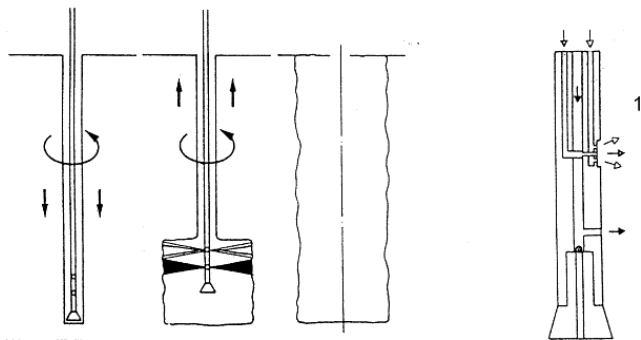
Jet Grouting - Injeção de água, de ar e de calda de cimento - Tipo 3. [20]
